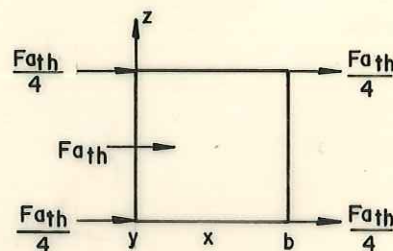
VENTO PERPENDICULAR A UM DOS LADOS DA PLANTA DA TORRE.
